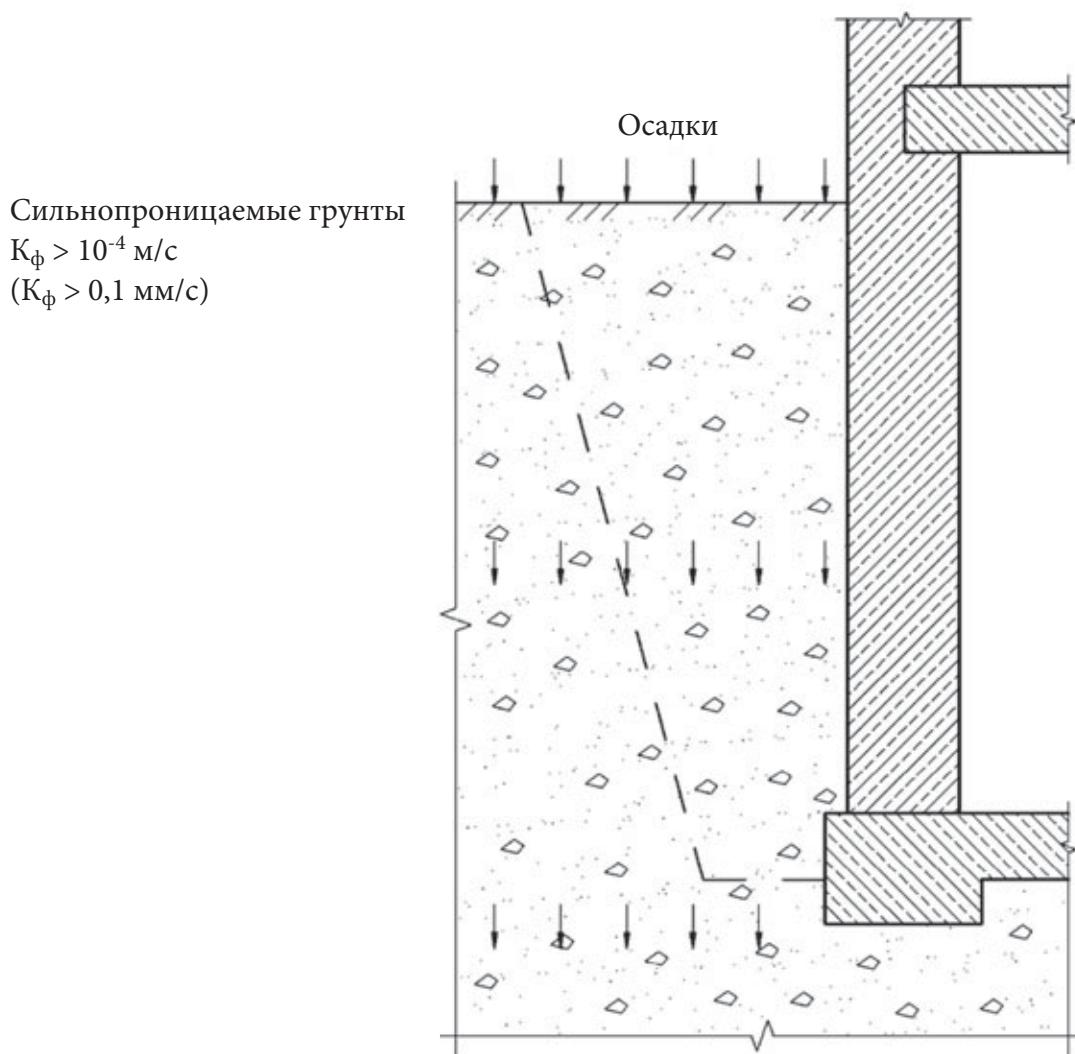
Расчетная схема нагрузки от воздействия грунтовой влаги
